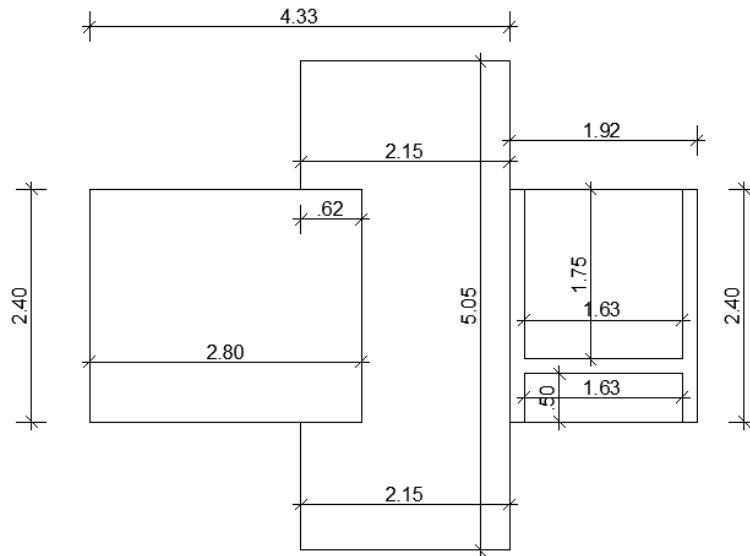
Medidas da escada, hall, poço do elevador e *shaft* para os cálculos das áreas dos pavimentos tipo.
